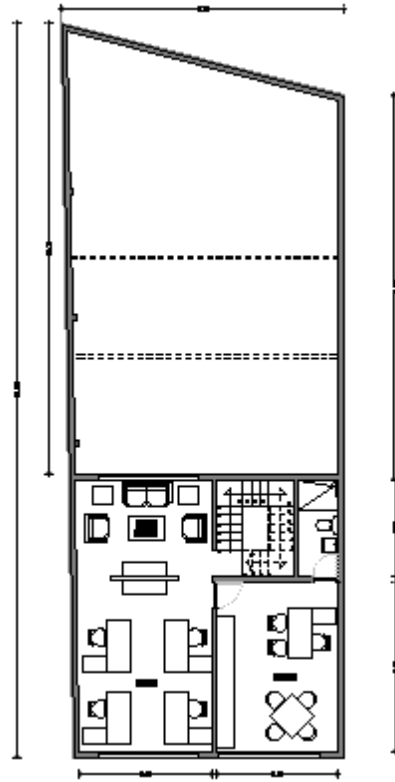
Planta alta de proyecto arquitectónico de adecuación (oficinas). Autoría propia.
